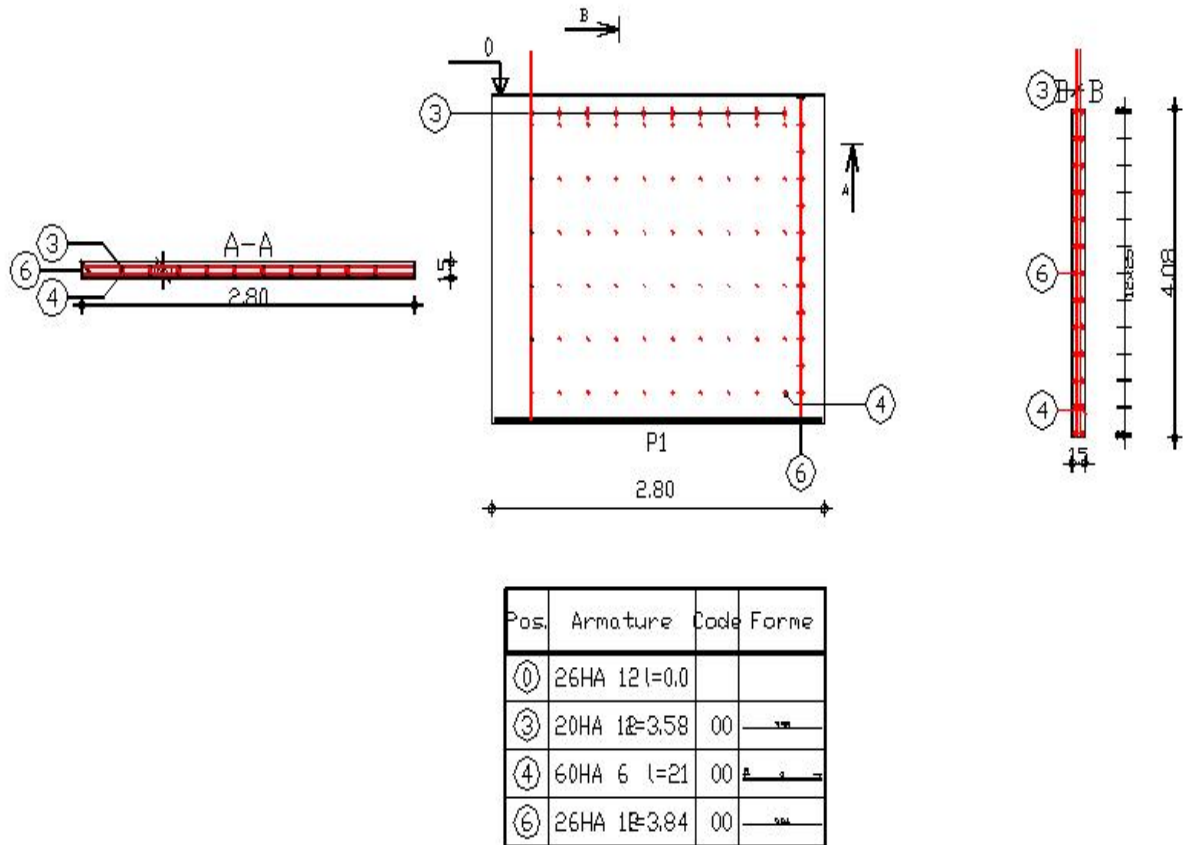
ferrailage de voile 15 cm coupe A-A et B-B
